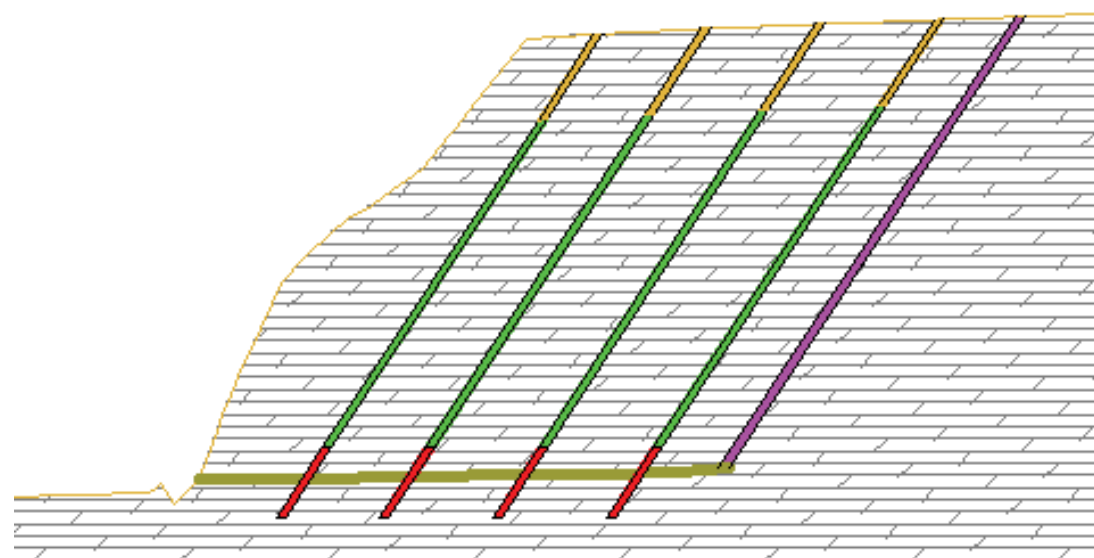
Voladura tipo en el tramo situado entre los PP.KK. 0+121 y 0+143
